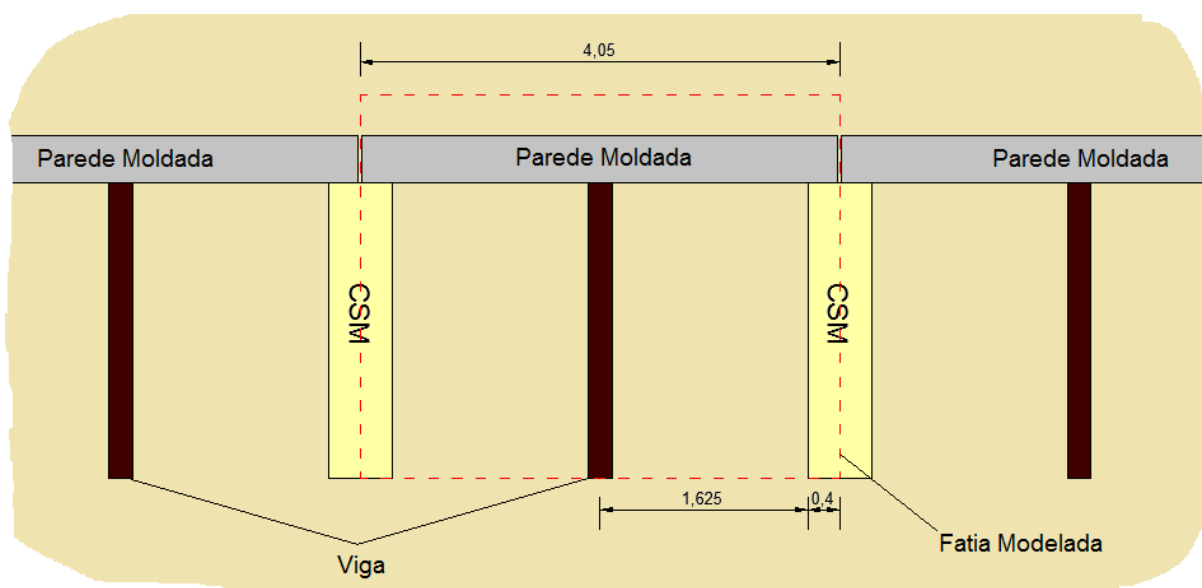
Escavação da estação Cais do Sodré no plano horizontal com painéis de CSM e fatia modelada (a tracejado).
